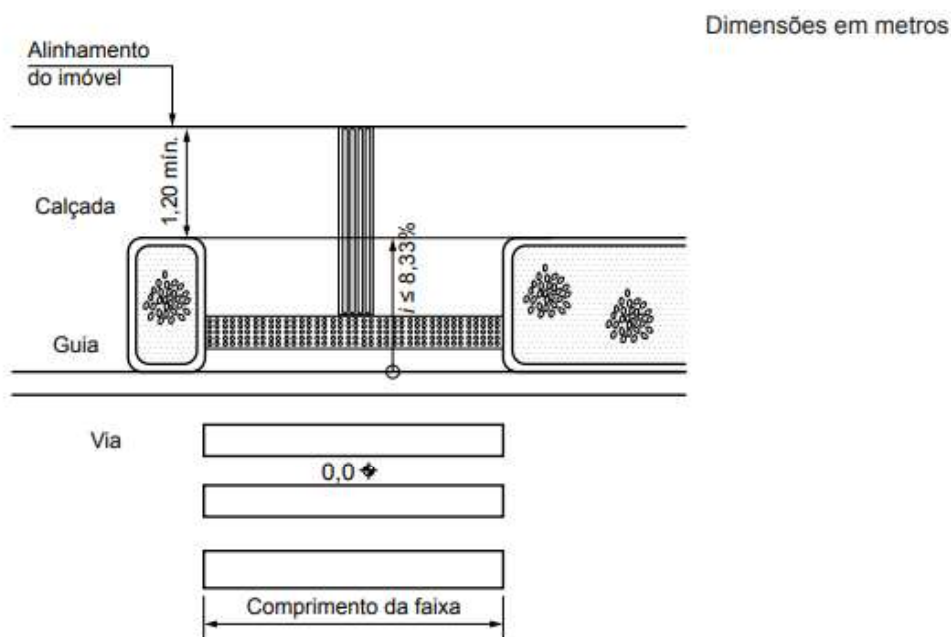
Rebaixamentos de calçada entre canteiros – Vista superior. Fonte: ABNT NBR 9050,2015.
